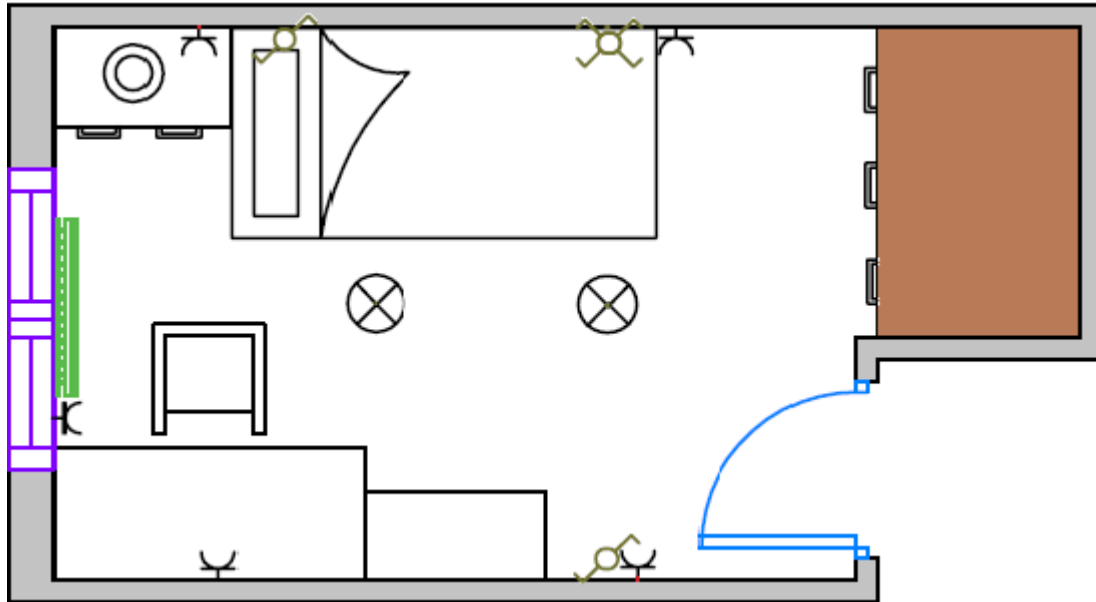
Plano de planta del dormitorio 3. Fuente: Elaboración propia
